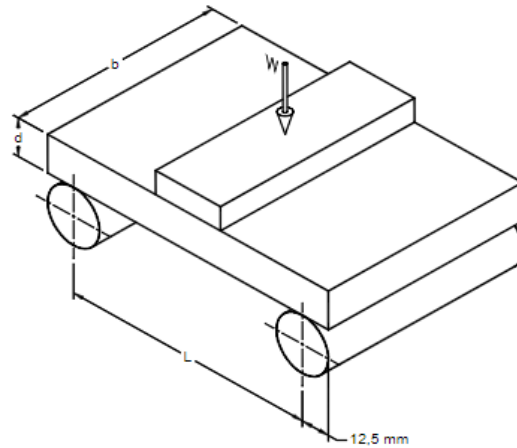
Diagrama del montaje módulo de rotura, fuente: tomada de la norma técnica 4017 del montaje módulo de rotura.
